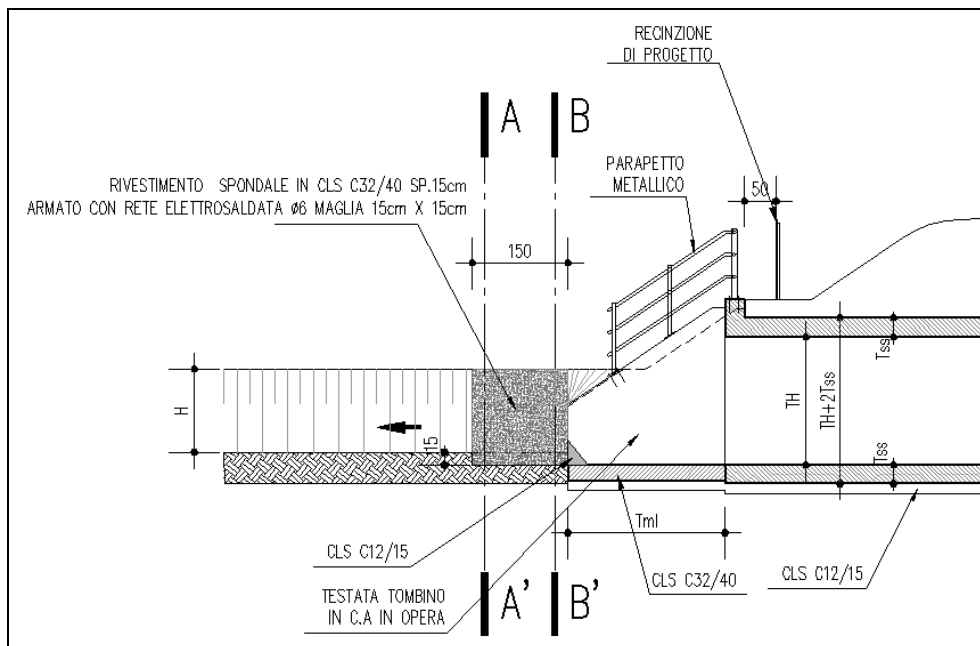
SEZIONE IMBOCCO/SBOCCO ATTRAVERSAMENTI PRIVATI
